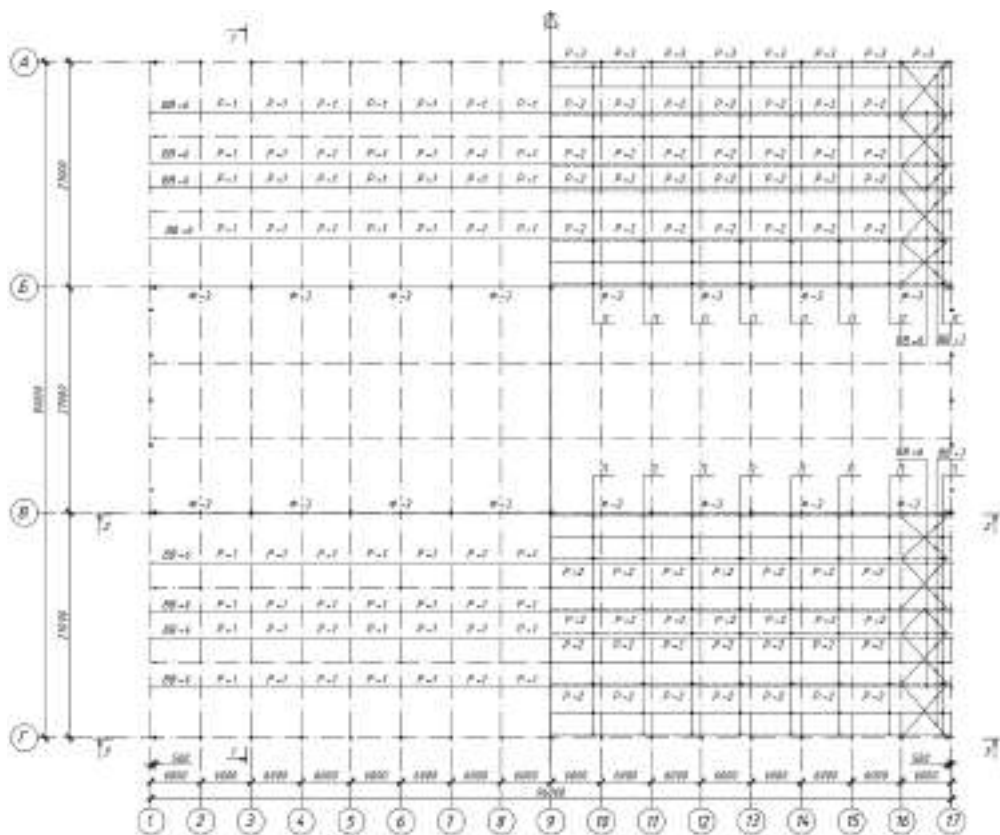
Схема розміщення елементів по нижньому поясу ферм Ф-1 / по верхньому поясу ферм Ф-1
